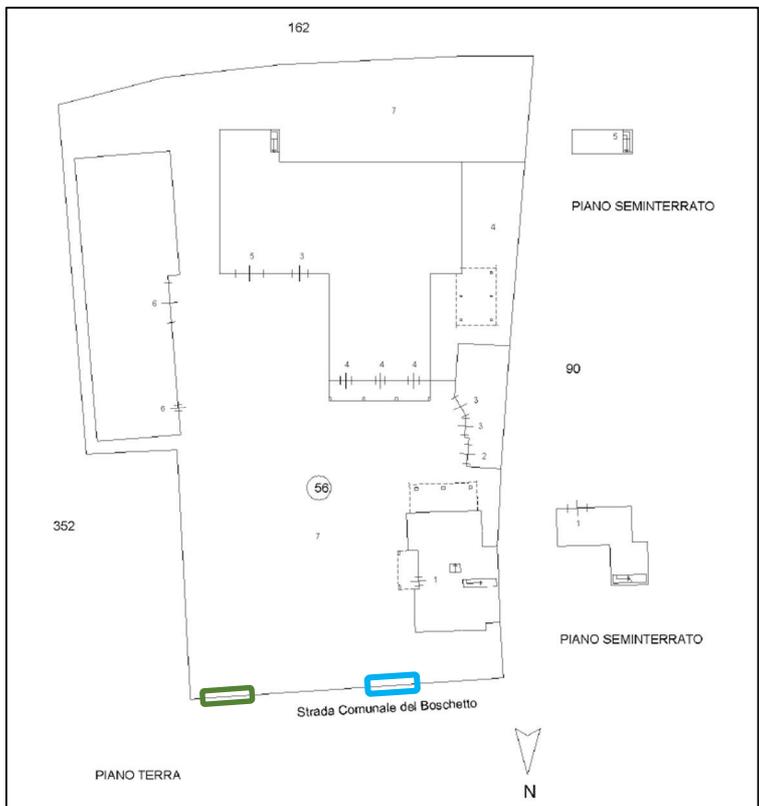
elaborato planimetrico con indicazione degli accessi alle unità (schema indicativo)
